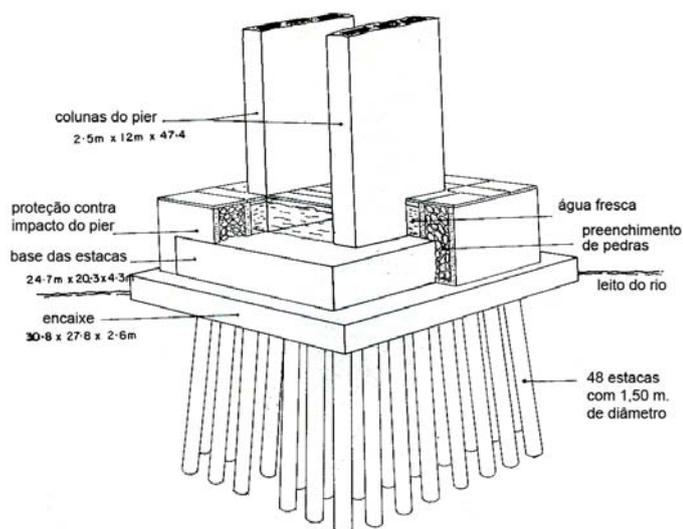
Fundações do pier 7 com estrutura de proteção contra impactos de navios (ROTOLONE, 1986).
